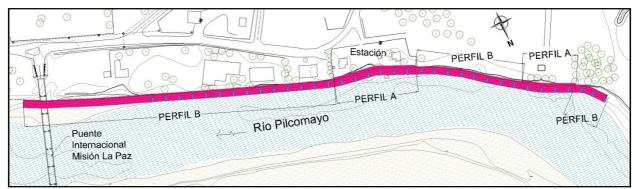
Planta Tramo recto aguas arriba del puente internacional y estribo.
